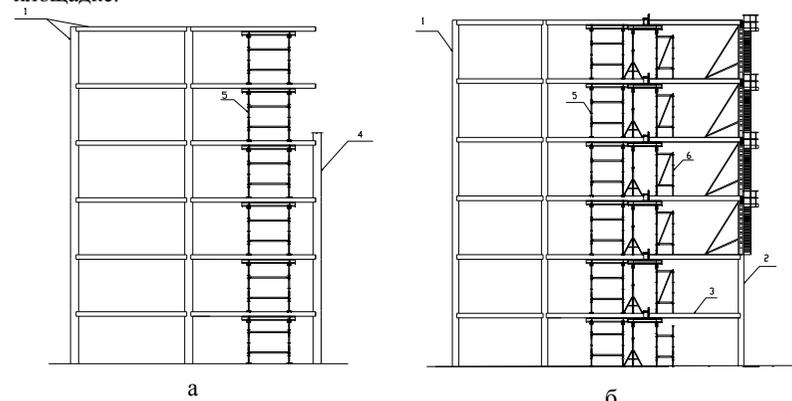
Технологическая схема замены несущих стен с подведением новых ригелей с перекрытием пристройки: а- установка временных опор и разборка наружной стены; б- бетонирование конструкции пристройки и ригеля
